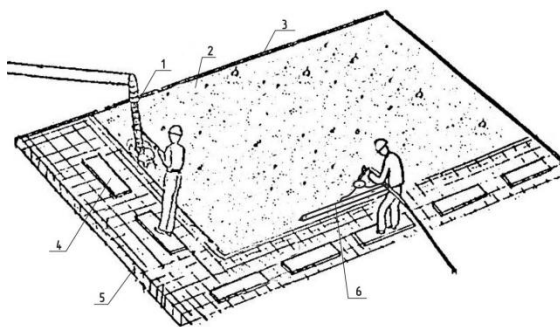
Организация рабочего места при бетонировании монолитной плиты автобетононасосом:
